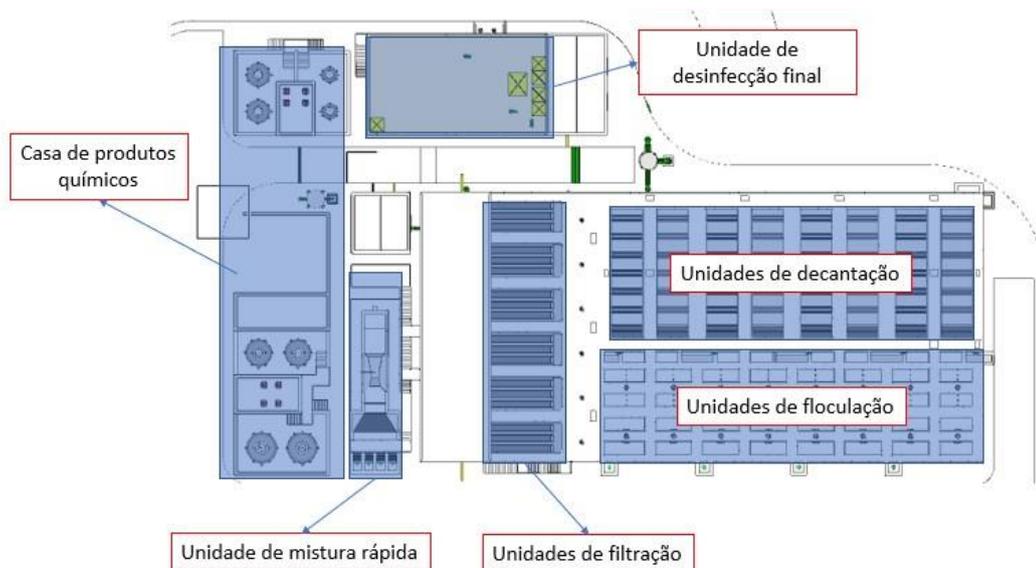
Layout de implantação da ETA. Fonte: Arcadis (2022)
